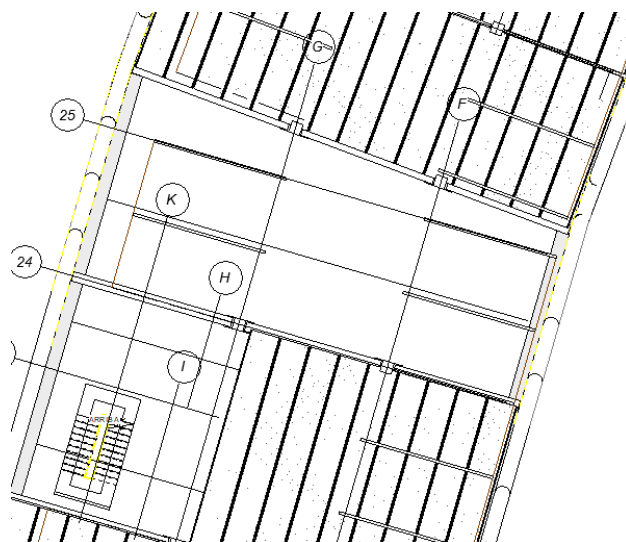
Zona de imposible colocación de placas alveolares. Fuente: Elaboración Propia.
